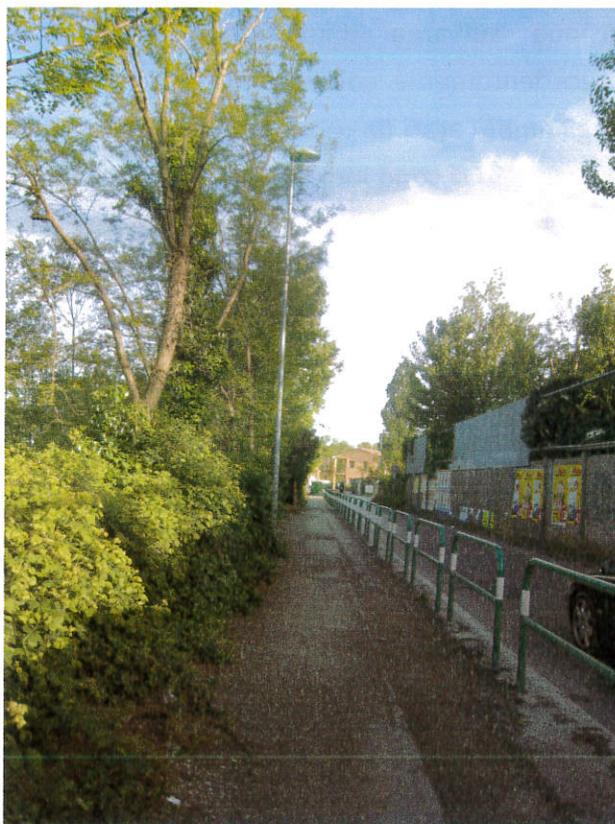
V.le Boschetto, viabilità carrabile e ciclopeditone
